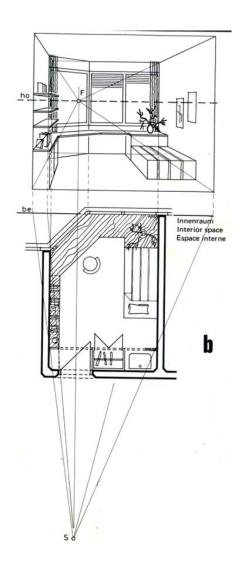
Construction d'une perspective centrale Figure 25 Construction d'une perspective d'angle intérieur (20)
